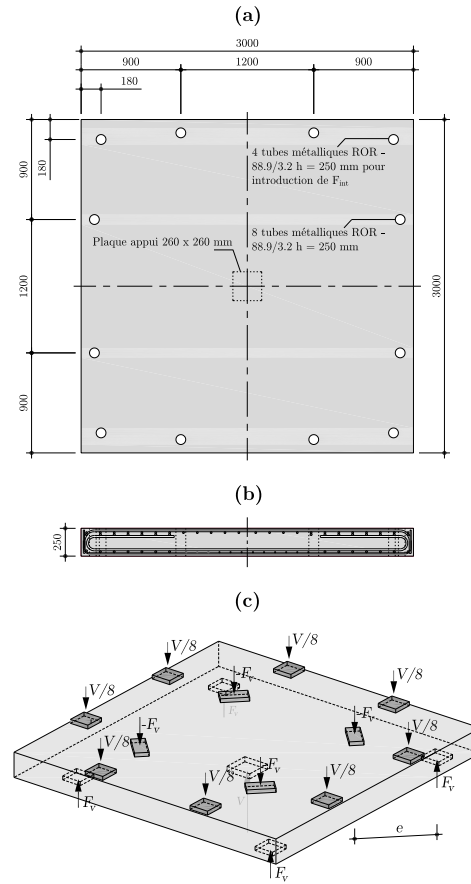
Dimensions des dalles d'essais au poinçonnement chargées par un moment de flexion: (a) Plan, (b) Coupe et (c) Schéma simplifié du principe de chargement
